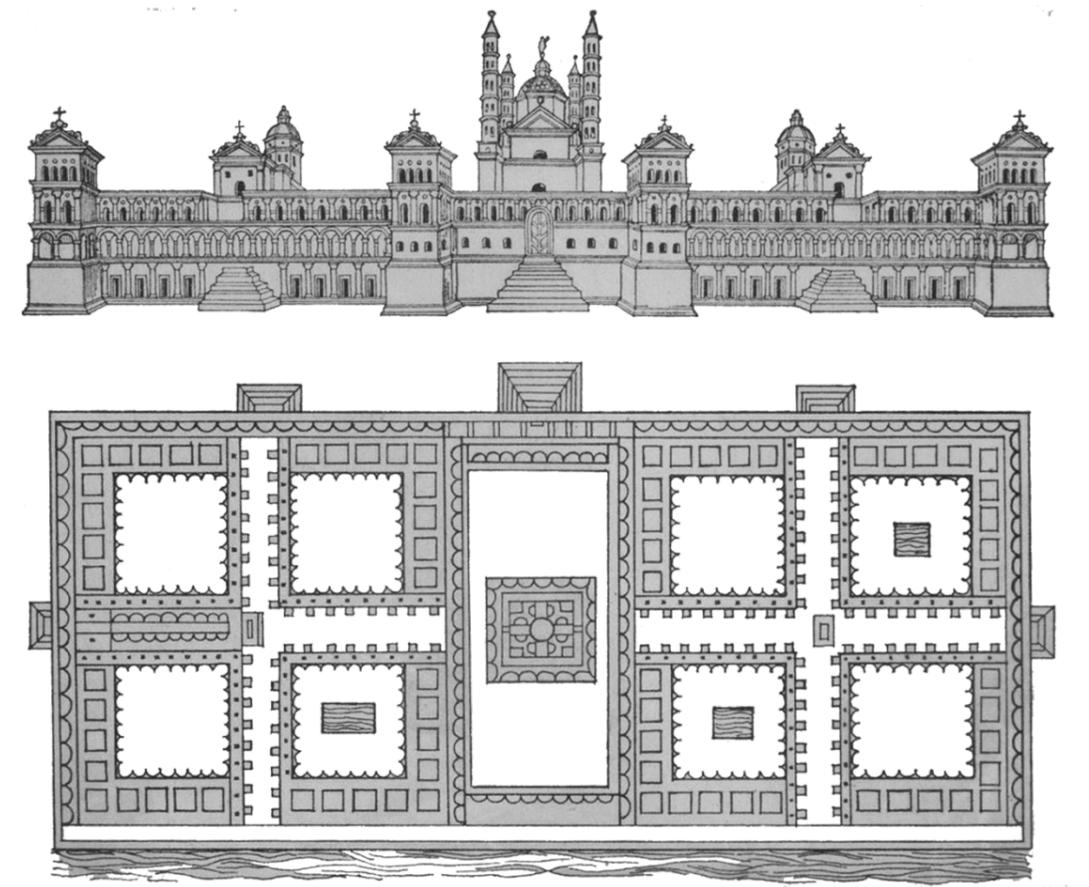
Ospedale Maggiore de Milán, planta y fachada principal
